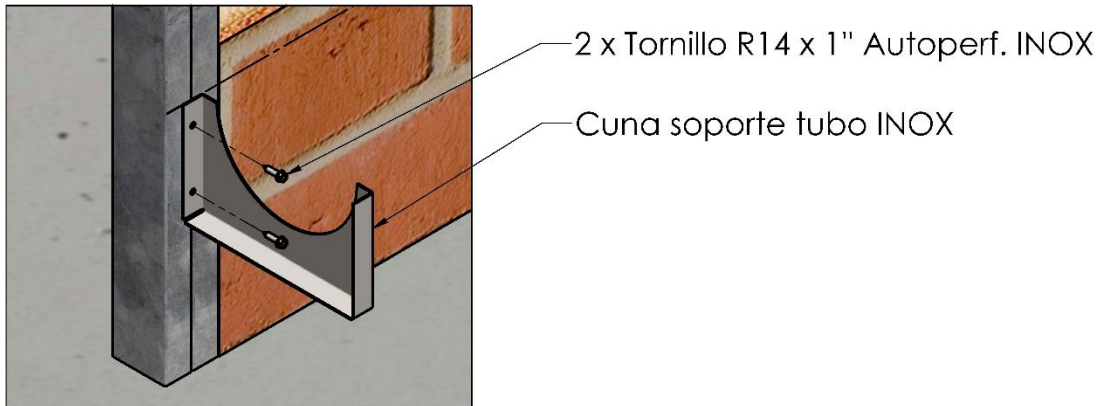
Instalación de Cunas soporte tubo INOX
